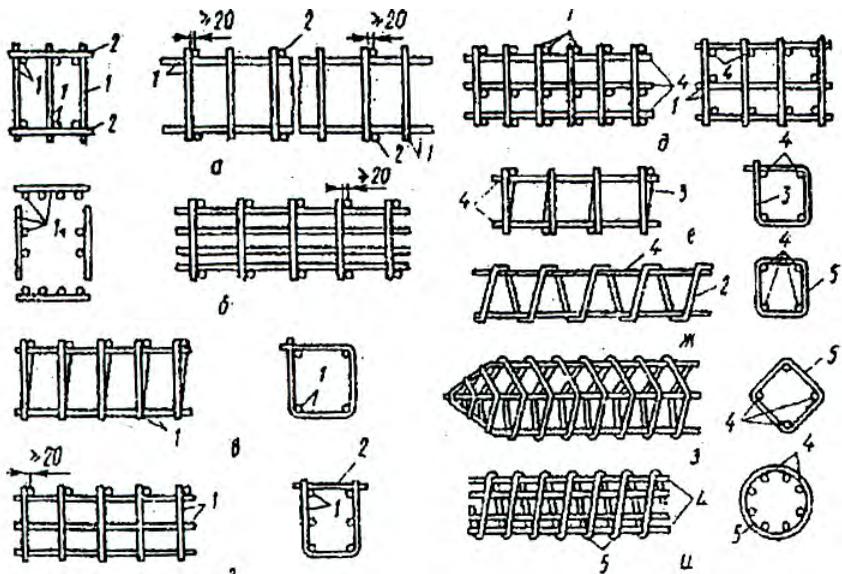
Примеры устройства пространственных арматурных каркасов: *а* – из плоских сеток, соединенных стержнями; *б* – объединением сеток сваркой; *в, г* – из гнутых сеток; *д* – из плоских сеток и продольных стержней; *е* – из продольных стержней и хомутов; *ж, з, и* – из продольных стержней с поперечной спиральной арматурой; 1 – сетки; 2 – соединительные стержни; 3 – хомуты; 4 – стержни продольной арматуры; 5 – поперечная спиральная арматура
